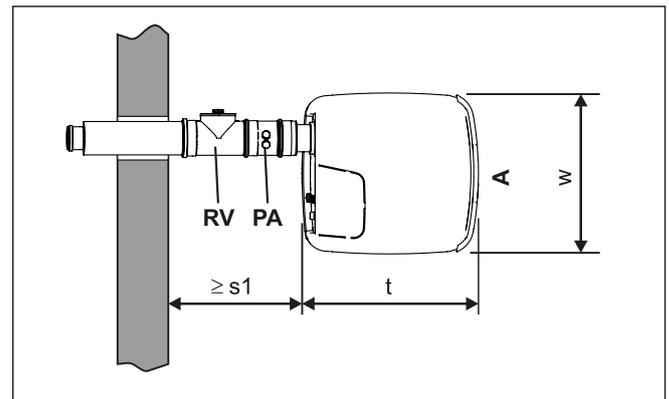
Draufsicht GCU compact Abgasanschluss nach hinten mit SET H (siehe Kap. 4.5.3) - (Maße siehe Tab. 4-1)
